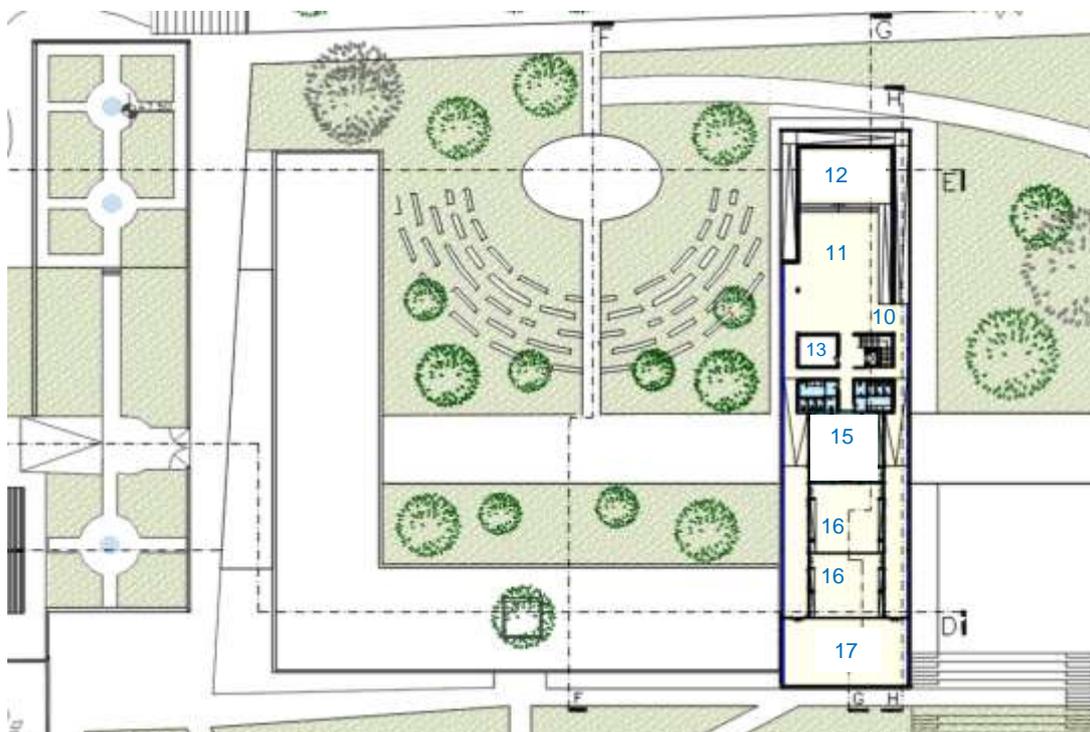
Planta piso 1 do Edifício Proposta – Centro Cultural (Fonte: autor, 2017)
